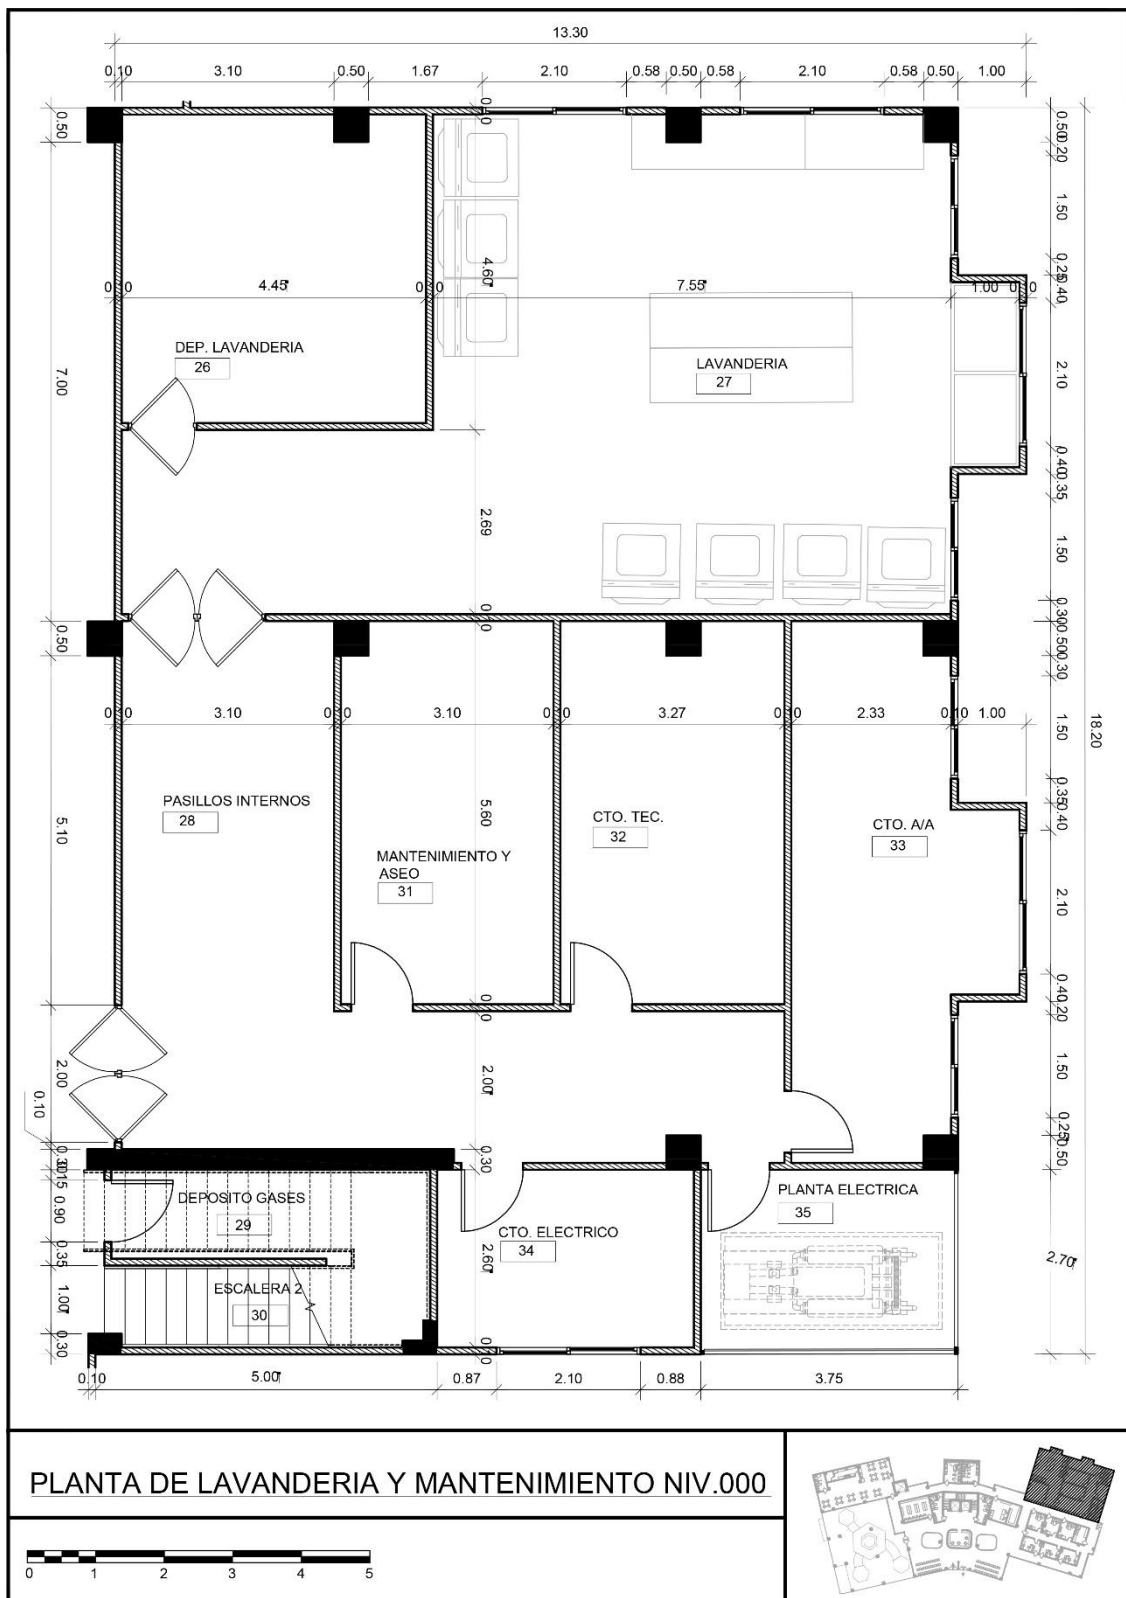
Área de lavandería y tecnología. Fuente el autor.
